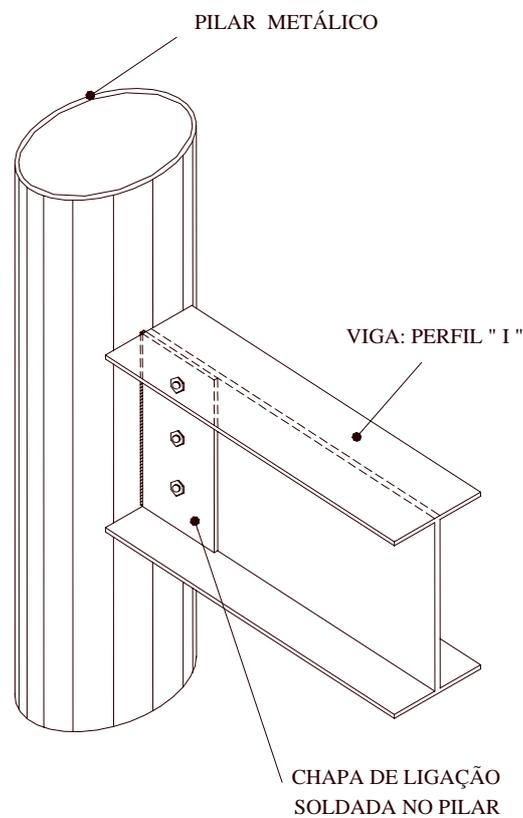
Detalhe da ligação entre a viga “I” e o pilar.
